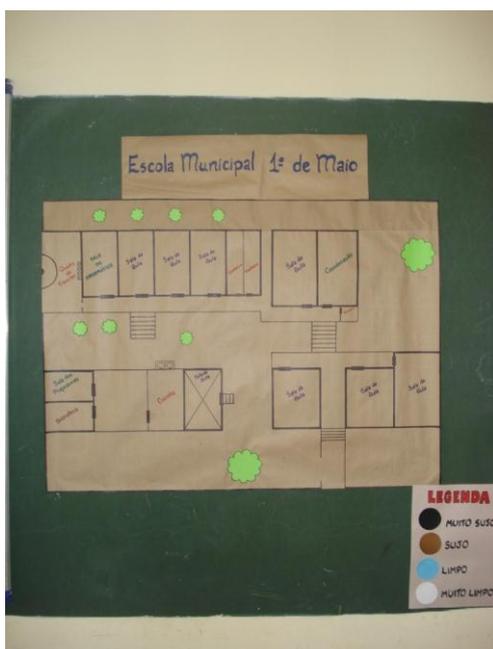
Planta baixa da Escola Municipal 1º de Maio
